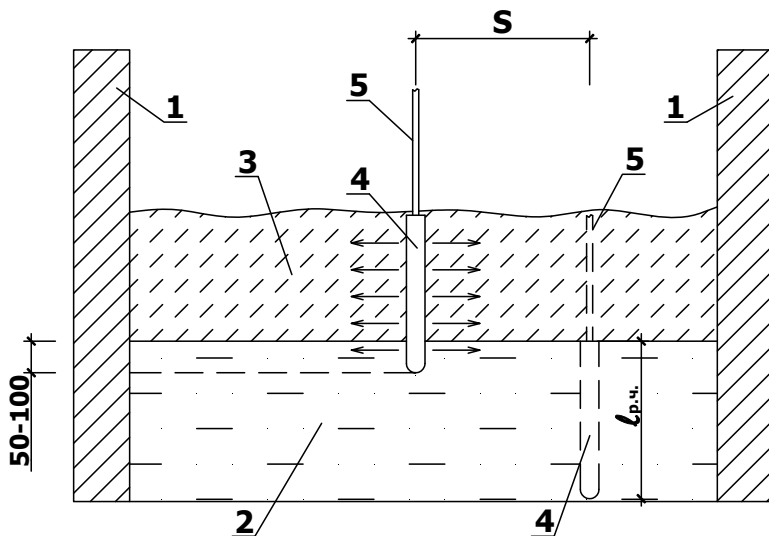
Схема послойного уплотнения бетонной смеси в опалубке:
